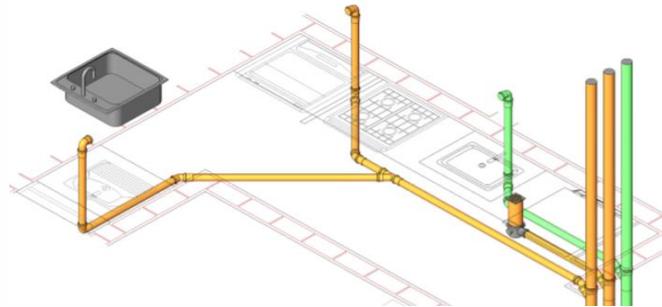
Compatibilização de instalações, arquitetura e estrutura de edificação
